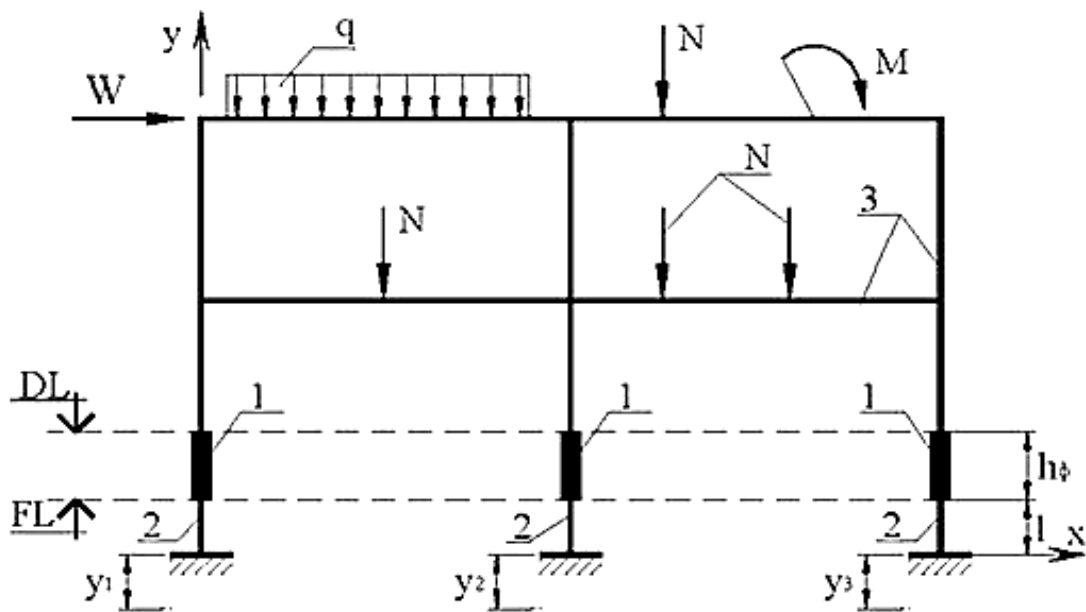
Розрахункова схема рами на стовпчастих фундаментах:
